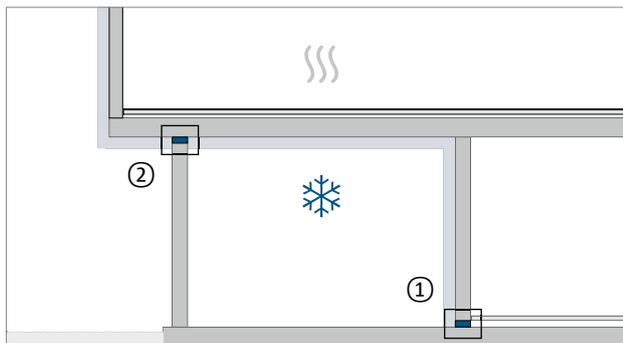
Mur extérieur de garage souterrain et poteau avec Schöck Sconnex®
